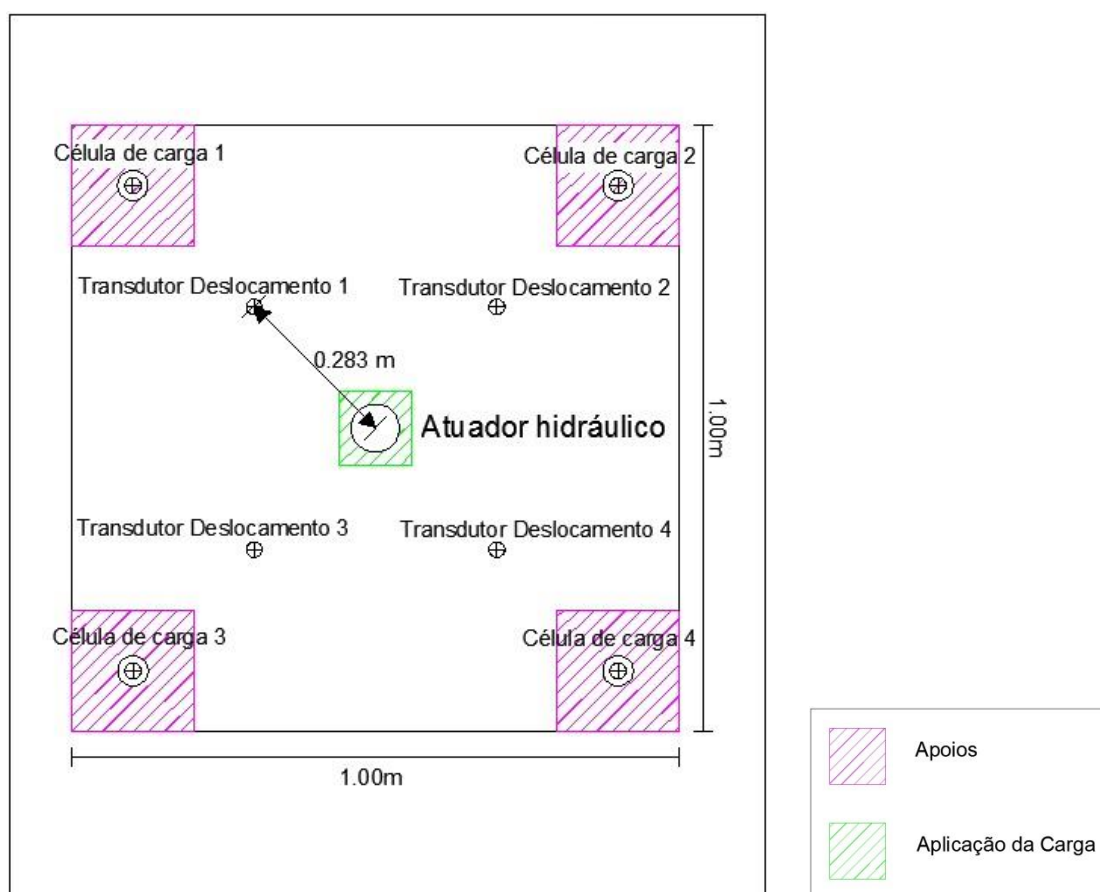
Pontos de instrumentação de cada laje ensaiada.
